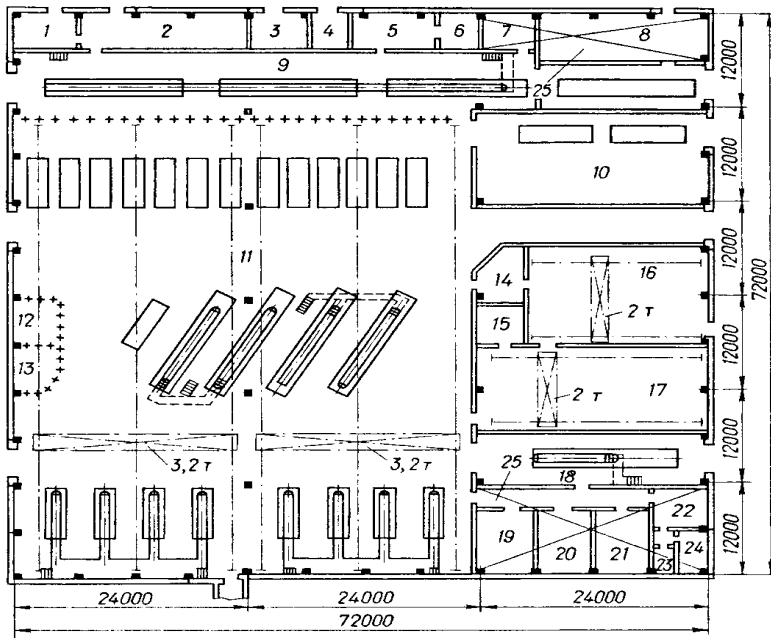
Головний виробничий корпус ВАТ (ЗАТ) АТП на 250 автопоїздів КамАЗ, КрАЗ, Мерседес: 1 — насосна складу масел; 2 — склад масел; 3 — трансформаторна підстанція; 4 — розподільний пристрій; 5 — дільниця ВГМ; 6 — комора дільниці ВГМ; 7 — санвузли; 8 — деревообробна й обойна дільниця; 9 — дільниця ТО-1; 10 — теплова дільниця; 11 — дільниця ТО-2 і ПР; 12 — відділ управління виробництвом; 13 — кімната майстрів і ВТК; 14 — проміжна комора; 15 — дільниця миття деталей; 16 — склад запасних частин, агрегатів і матеріалів; 17 — слюсарно-механічна й агрегатна дільниця; 18 — дільниця поглибленої діагностики; 19 — тепловий пункт; 20 — дільниця ремонту паливної апаратури; 21 — дільниця ремонту електроустаткування; 22 — акумуляторна дільниця; 23 — кислотна; 24 — зарядна; 25 — вентиляційна камера (на антресолях)
